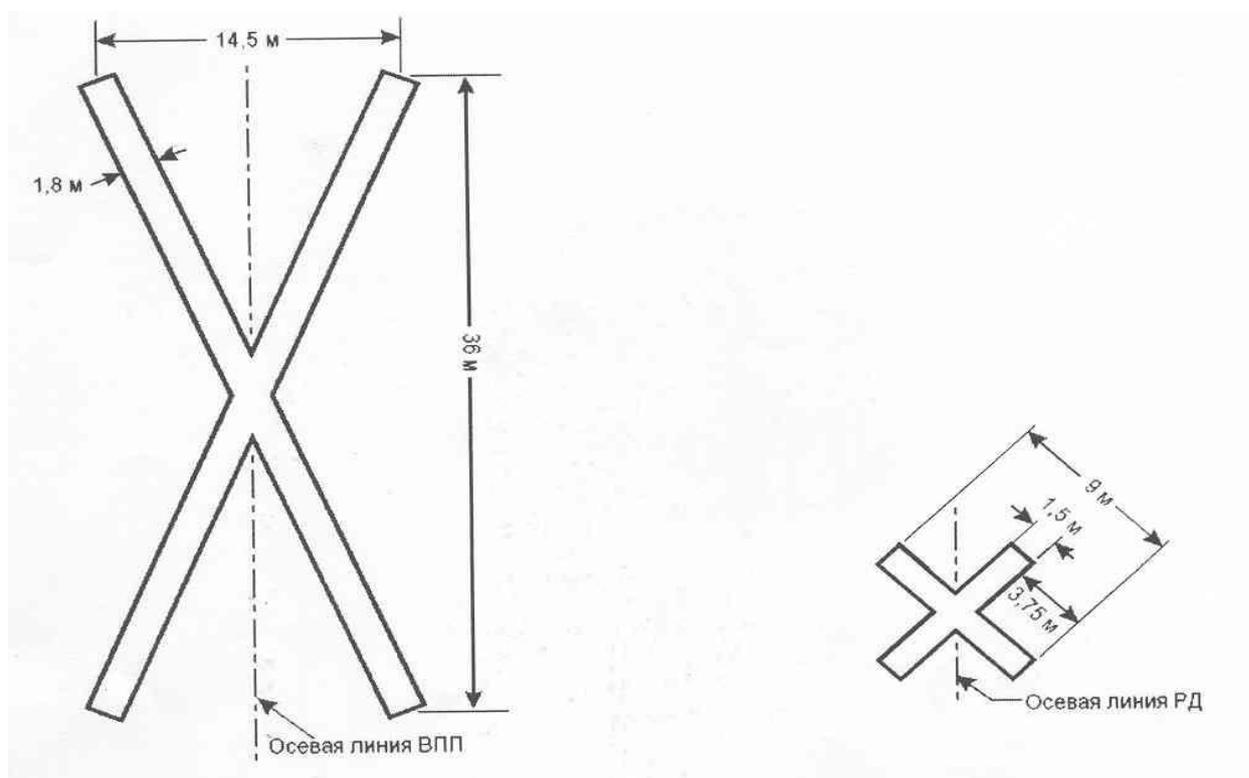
Маркировка закрытых для движения ВПП и РД
